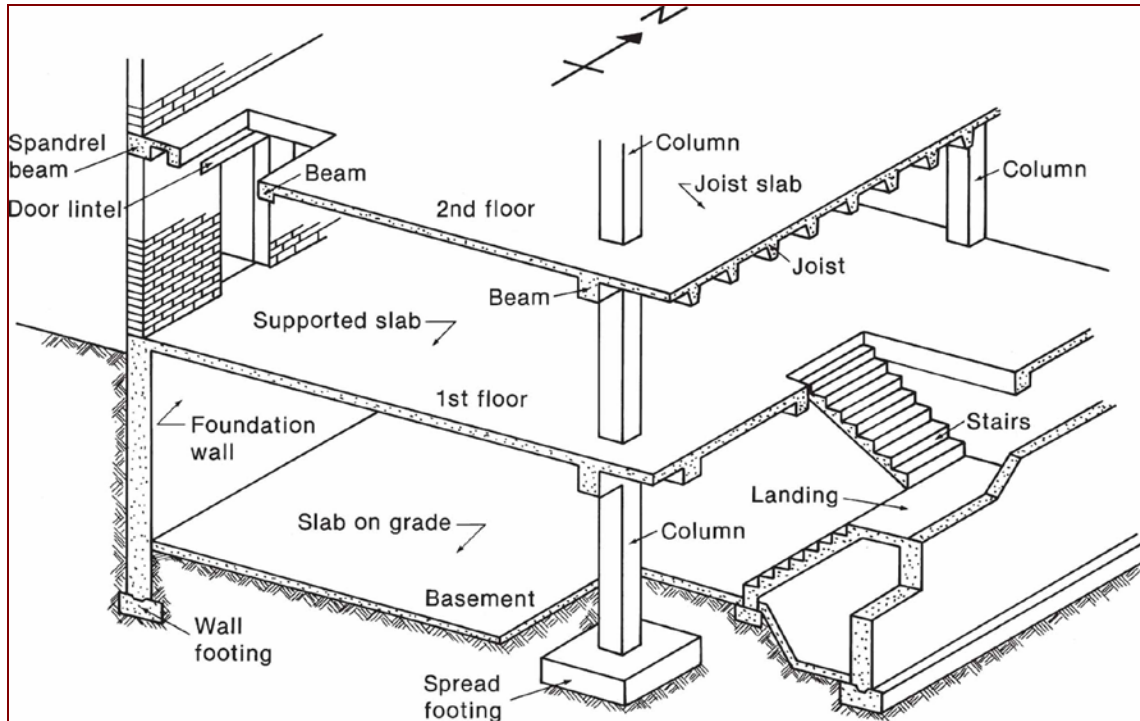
Elementos de un edificio de concreto reforzado. (Tomado de CRSI, 1971)
